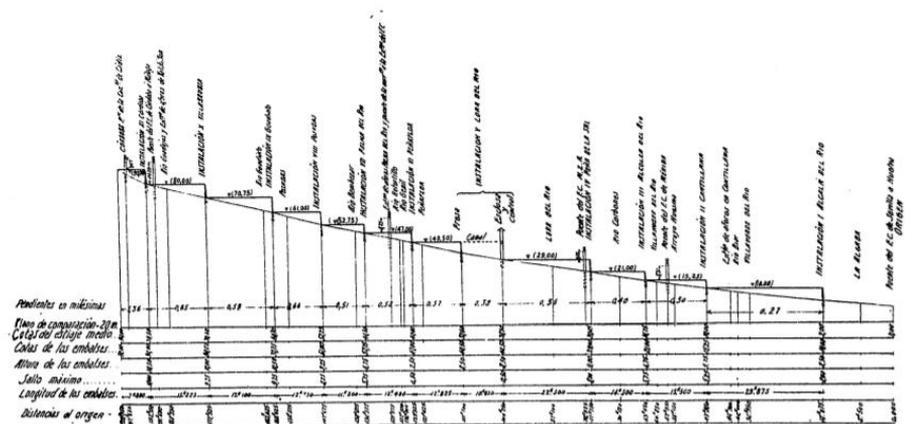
Perfil longitudinal de la canalización y aprovechamiento de energía del río Guadalquivir entre Córdoba y Sevilla (Mendoza, 1926).
